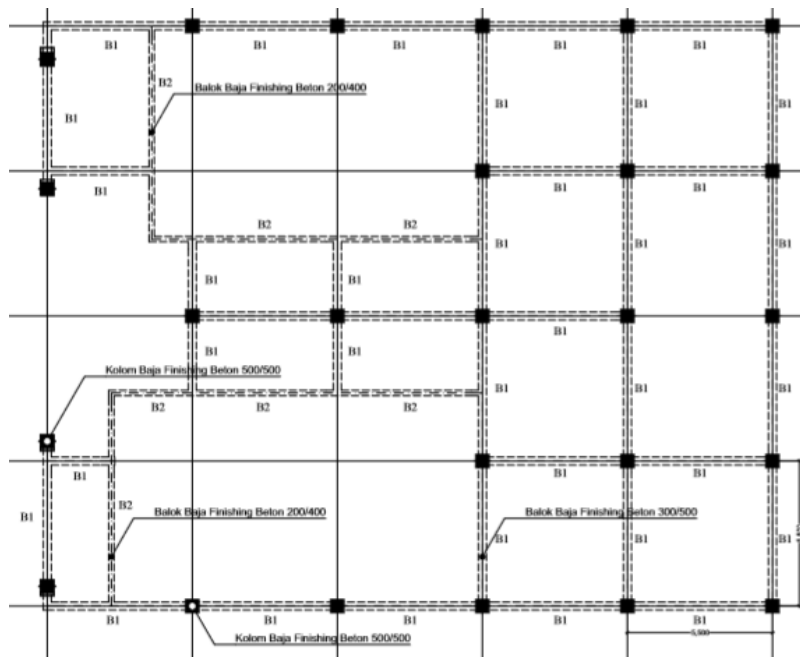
Struktur Kolom dan Balok Ground Floor.
